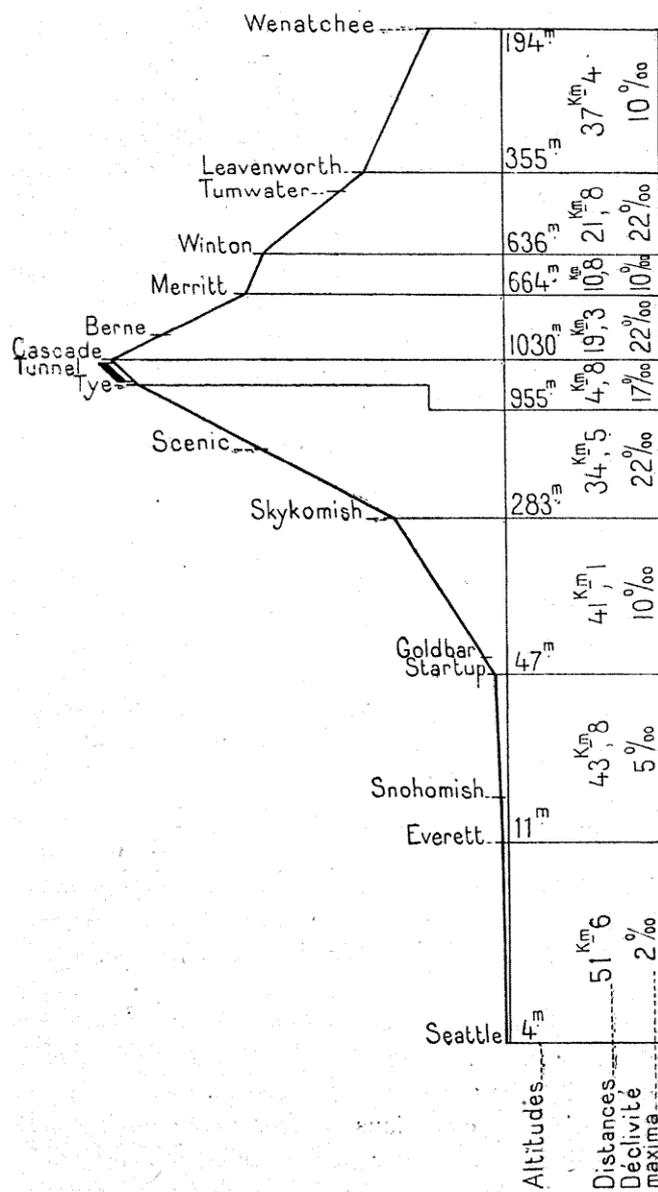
Great Northern Railway : profil de la traversée de la Cascade Range.
